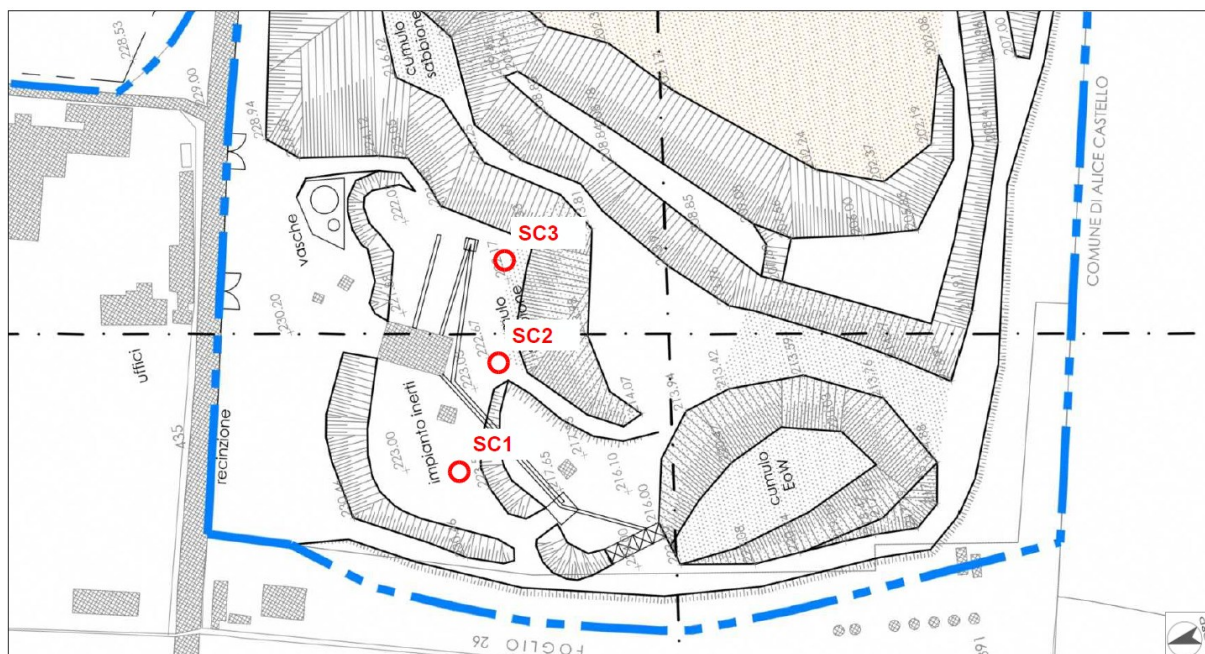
Stralcio tavola 1 con ubicazione degli scavi
